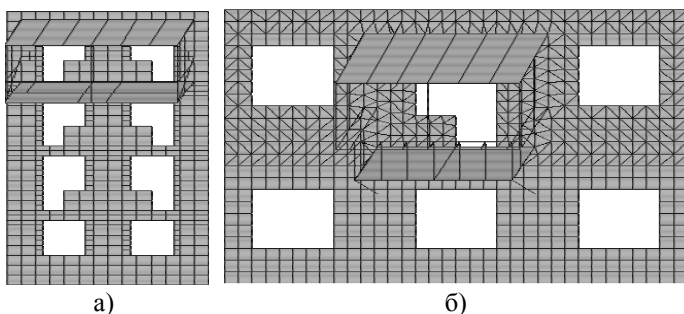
Фрагменты расчетных моделей зданий с усилением балконов: а) установкой тяжей; б) подкосами
